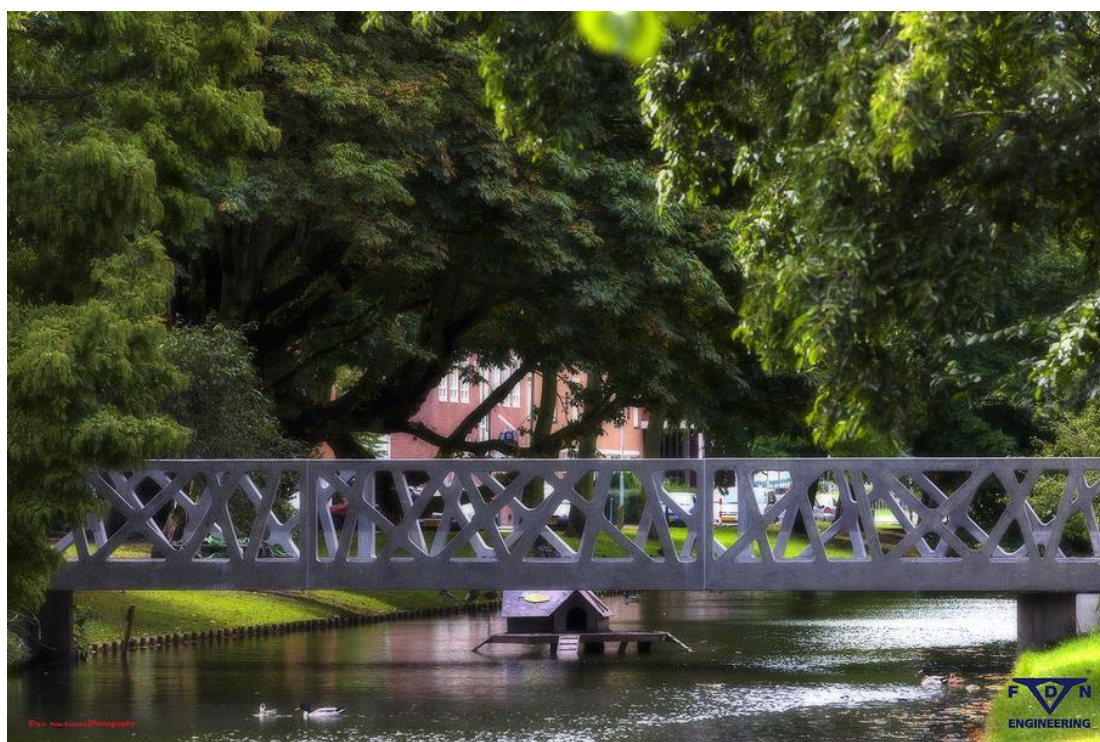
UltraBridge executada pela FDN-Engineering na Holanda, Roterdão (FDN-Engineering)
